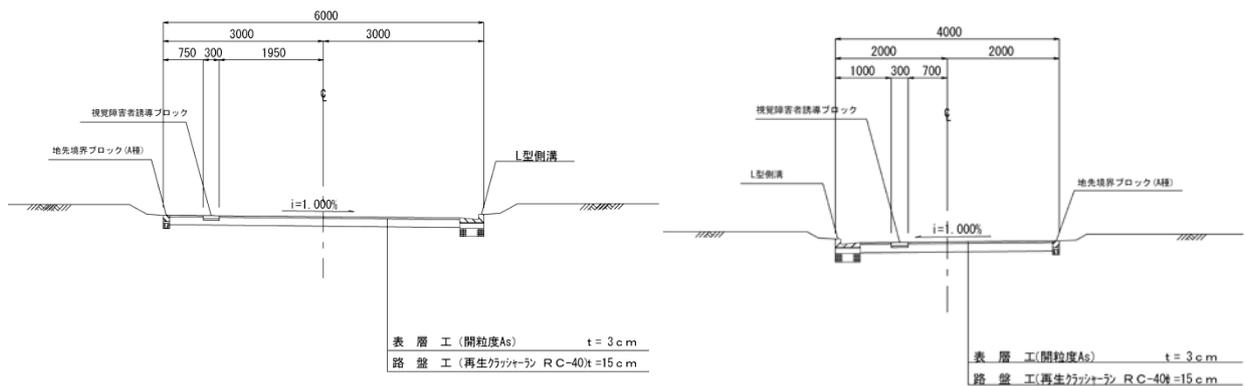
(7) 道路断面図(歩行者専用道路標準断面)
